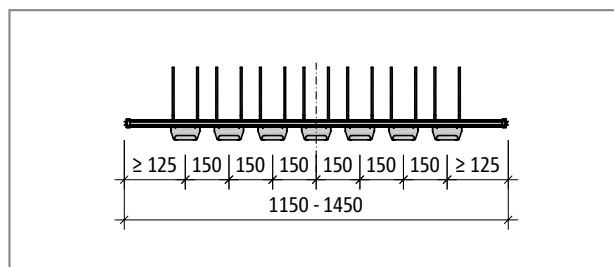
Schöck Tronsole® tipo T-V7-H...-L1150 - L1450: pianta del prodotto
